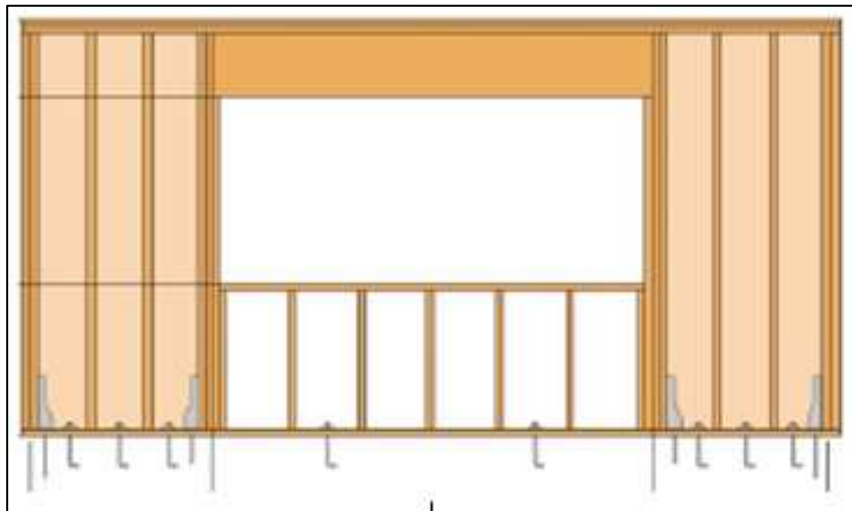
Muro de corte de madera segmentado. Fuente: (WoodWorks - Wood Product Council, 2016)
